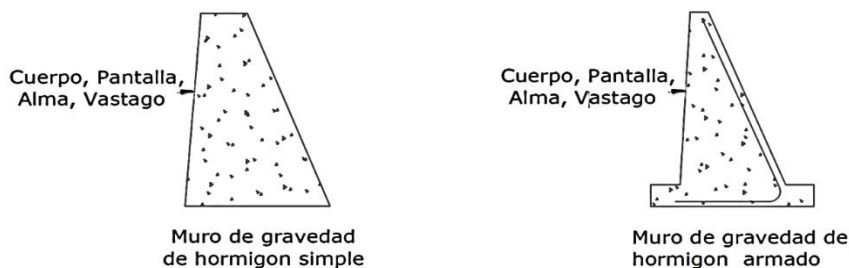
ESTRIBO TIPO GRAVEDAD
